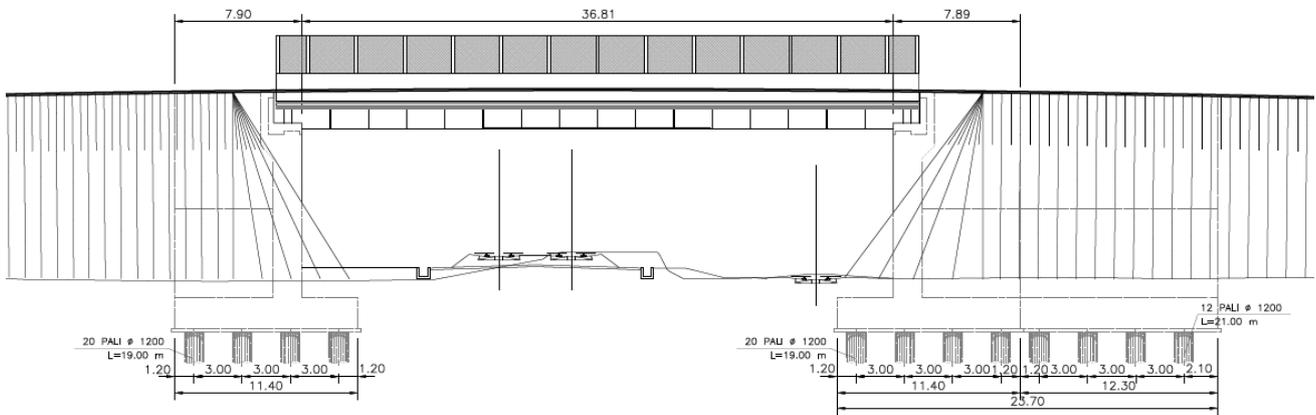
Sezione longitudinale del cavalcaferrovia IV15 nel progetto in variante
